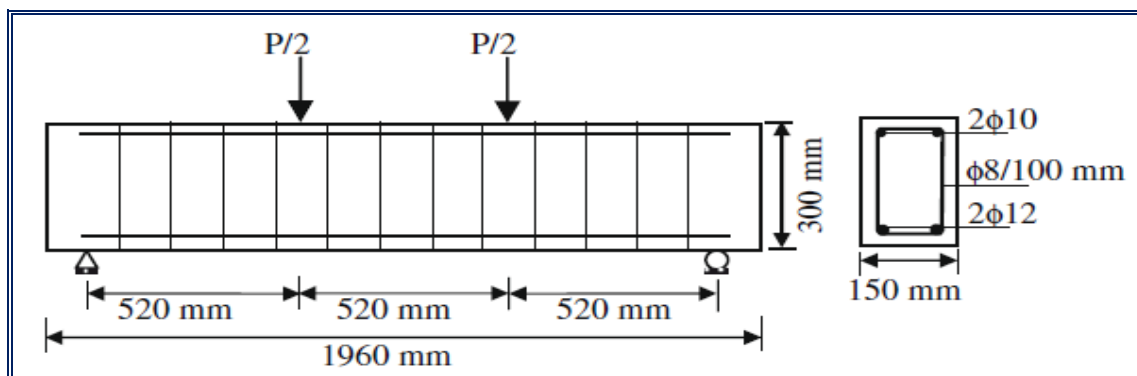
ESQUEMA DE ENSAIO DAS VIGAS DE OBAIDAT (2007).
